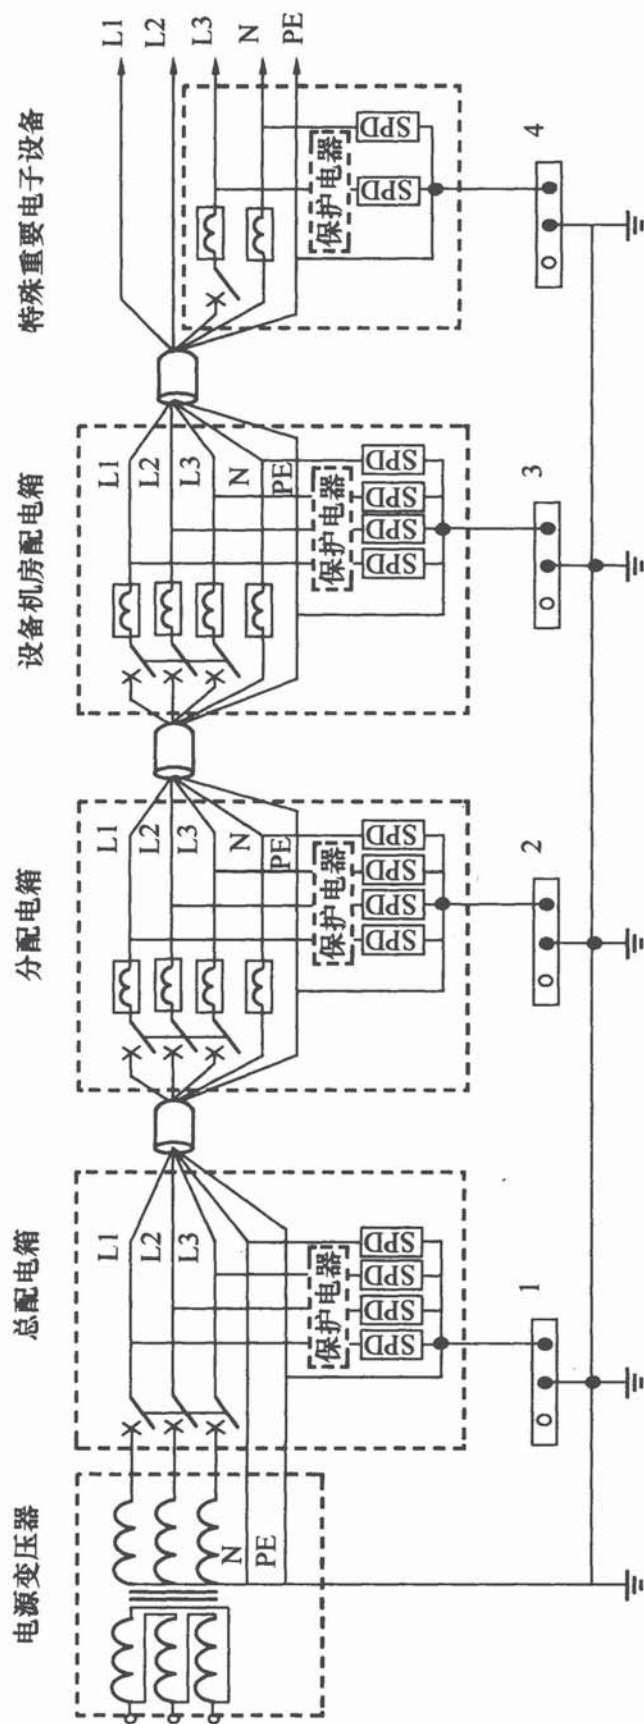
TN-S 系统的配电线路浪涌保护器安装位置示意图
